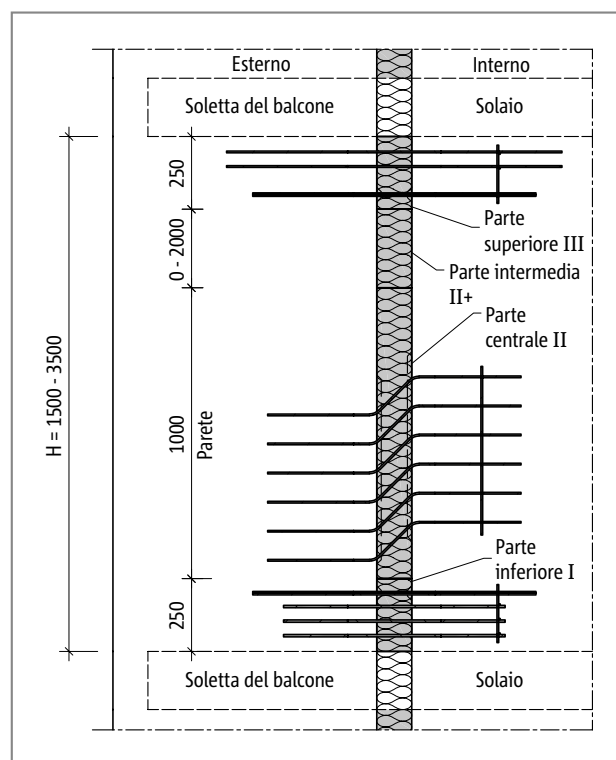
Schöck Isokorb® tipo WXT: balcone con lastre delle pareti portanti e termoisolate
